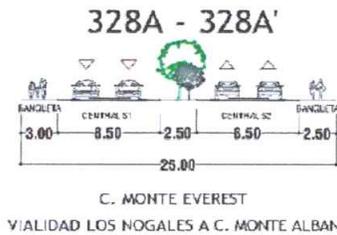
Sección vial actual C. Monte Everest. Fuente PDU 2040 vigente.
